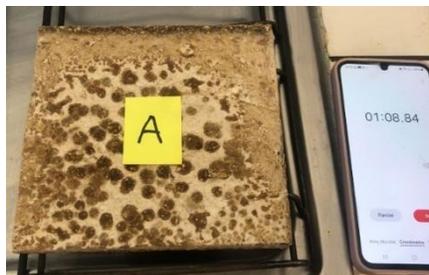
Exposición al fuego prototipo A. Fuente propia.
